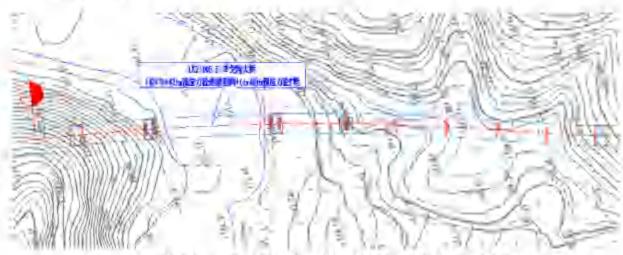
从江南互通连接线(L 线)宰戈河大桥桥位平面布置图
